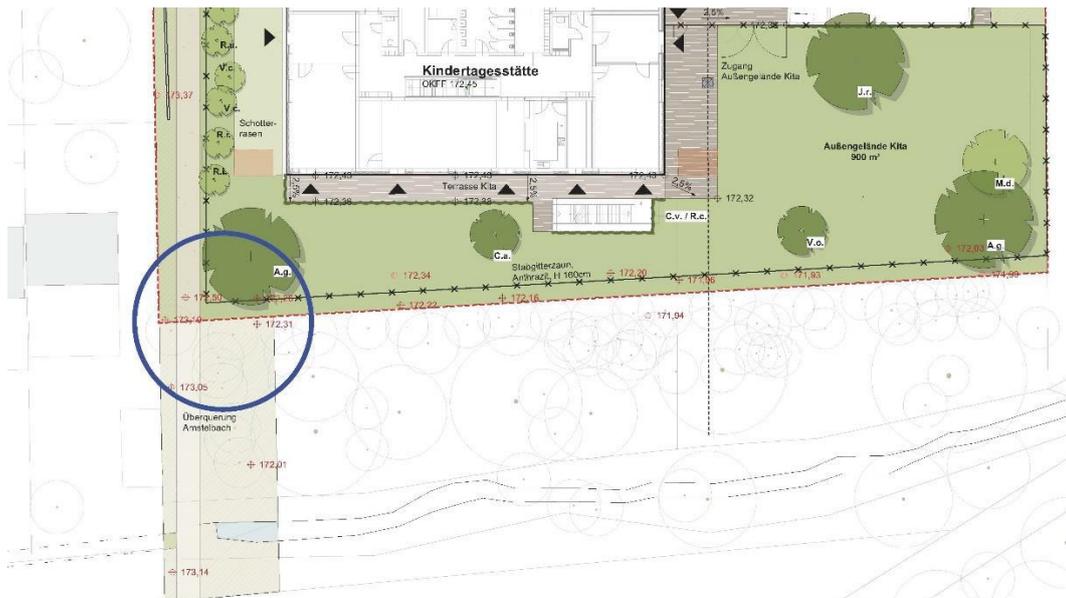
Fußweg über den Amstelbach, Ausschnitt Lageplan GROW
